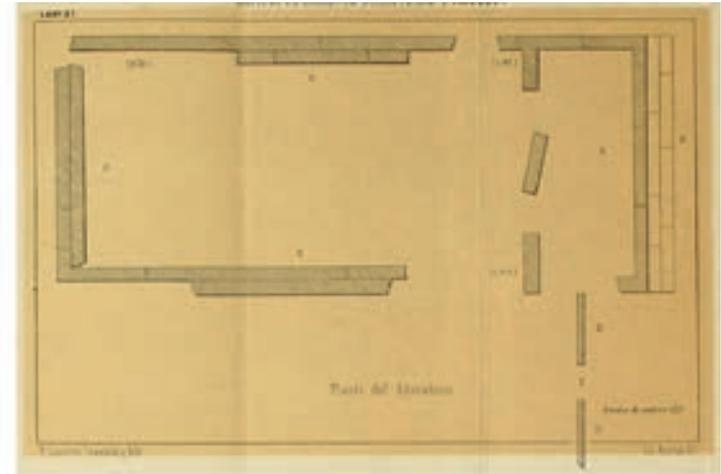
Plano de Savirón y planta esquemática de las estructuras del Cerro de los Santos.
